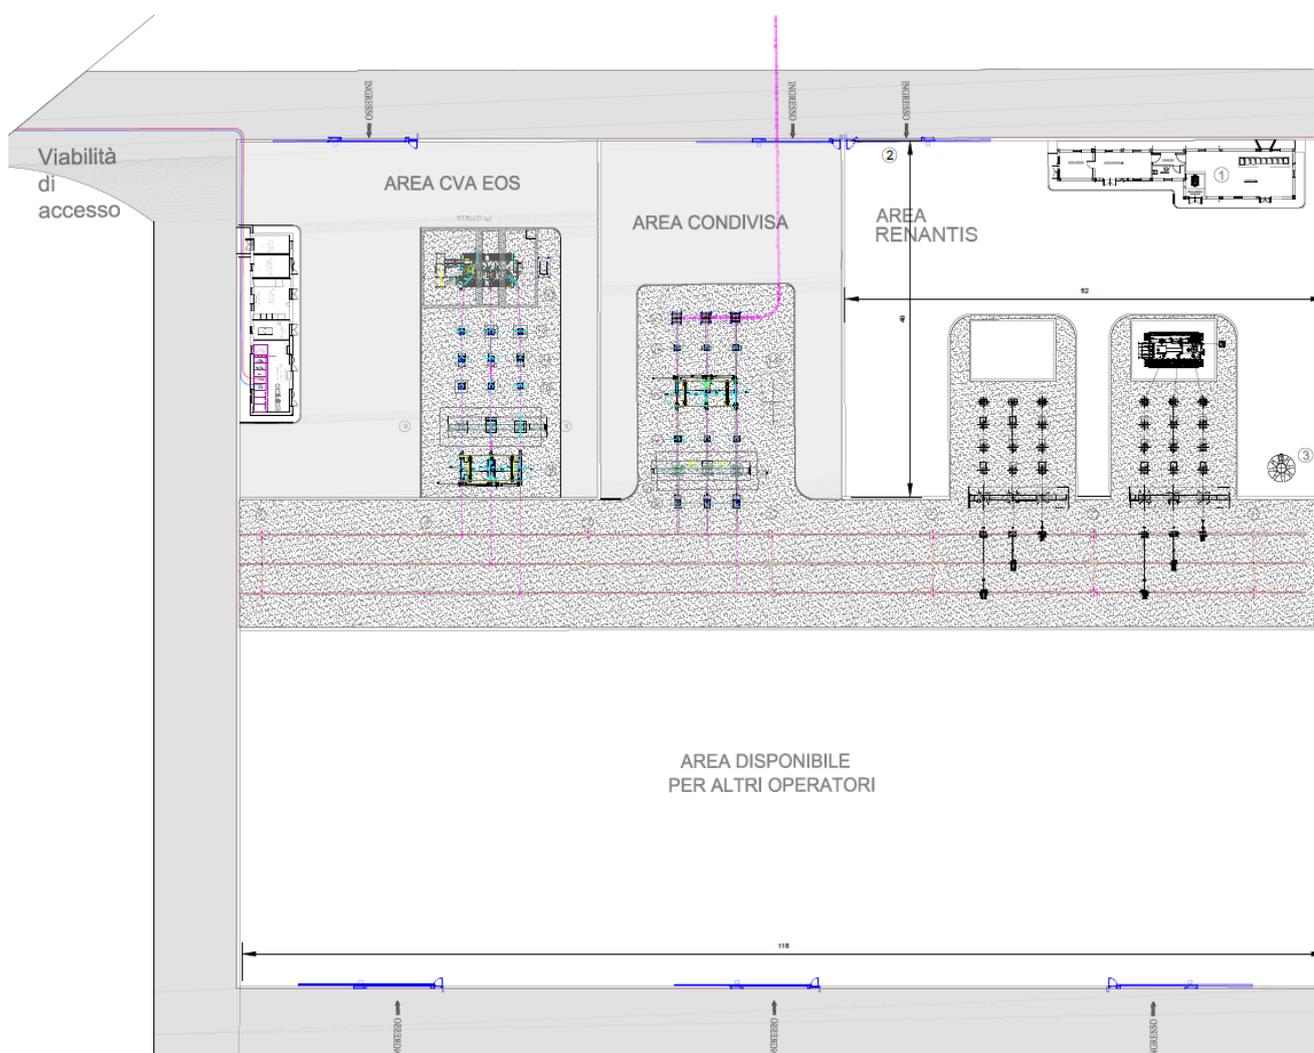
Planimetria elettromeccanica della Stazione Trasformazione Renantis
